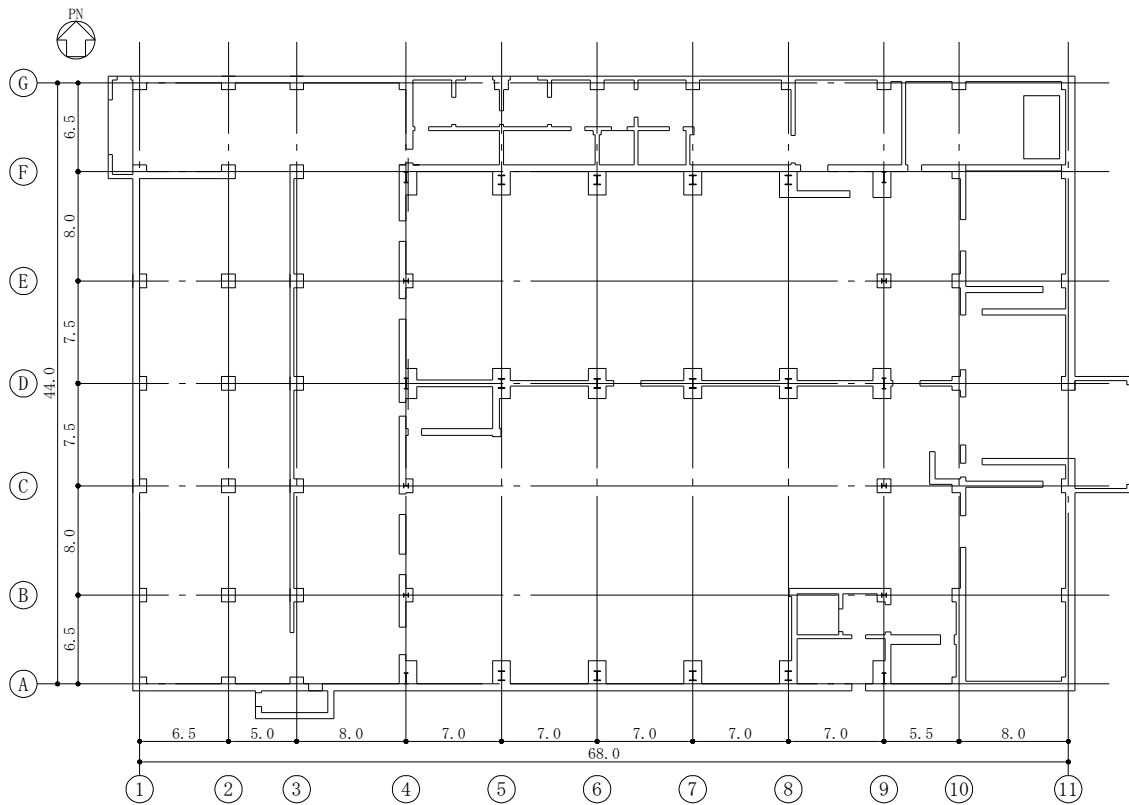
1階平面図 (G.L. +0.25) (単位 : m)
